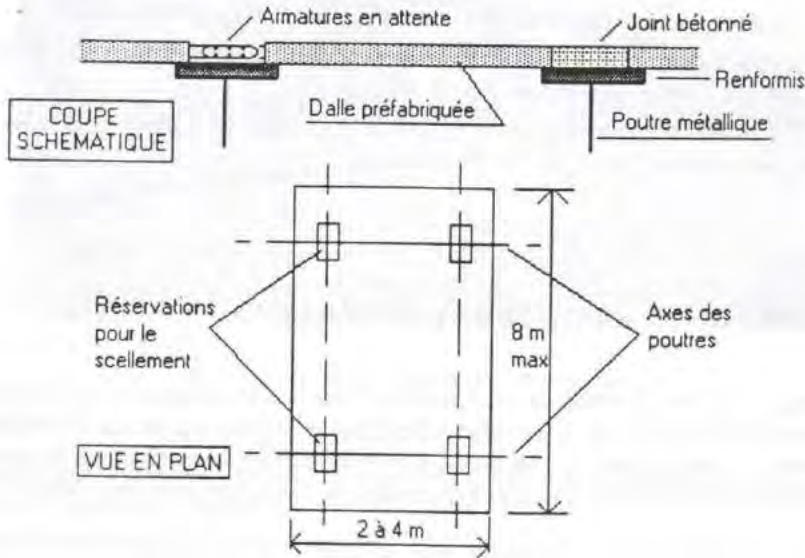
Dalles préfabriquées : dispositions d'ensemble.
